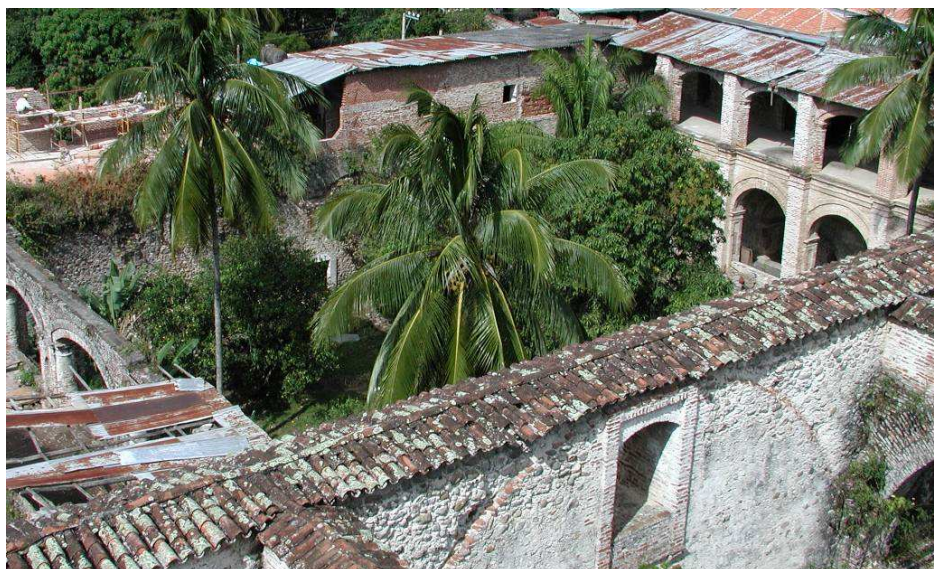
Vista de la planta alta de las crujiás noroeste y noreste (fotografía de la autora).
